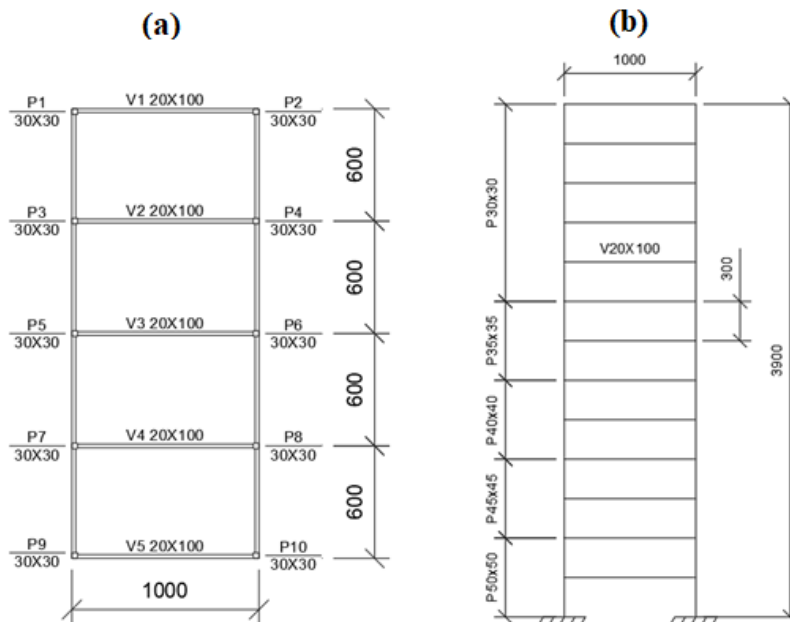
(a) Planta de forma da estrutura. (b) Pórtico central da estrutura (medidas em centímetros)
